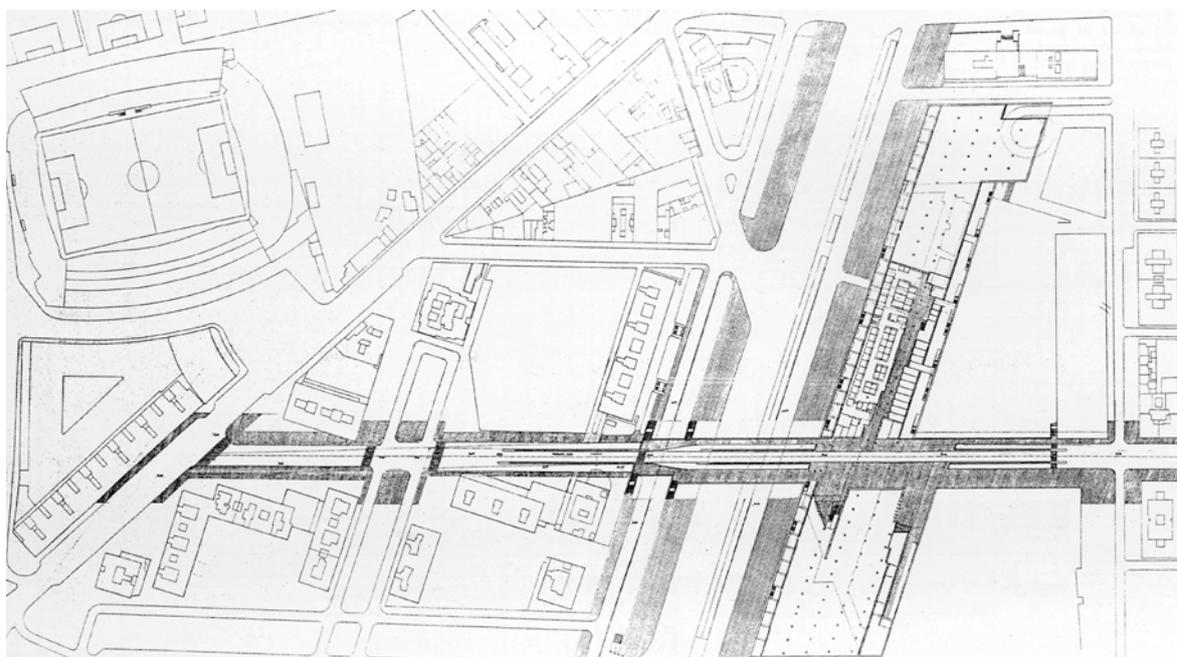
Planta paso subterráneo calle Constança, proyecto ejecutivo L'illa Diagonal.
